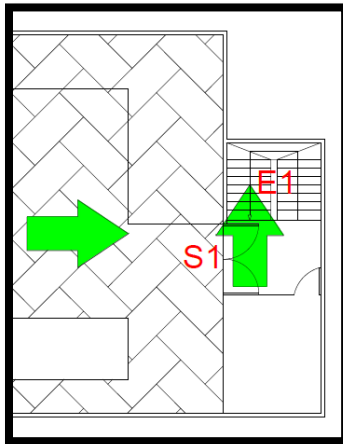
“Planta de angostamiento salida 1 y arranque escalera 1, del segundo piso del recinto 2.”
